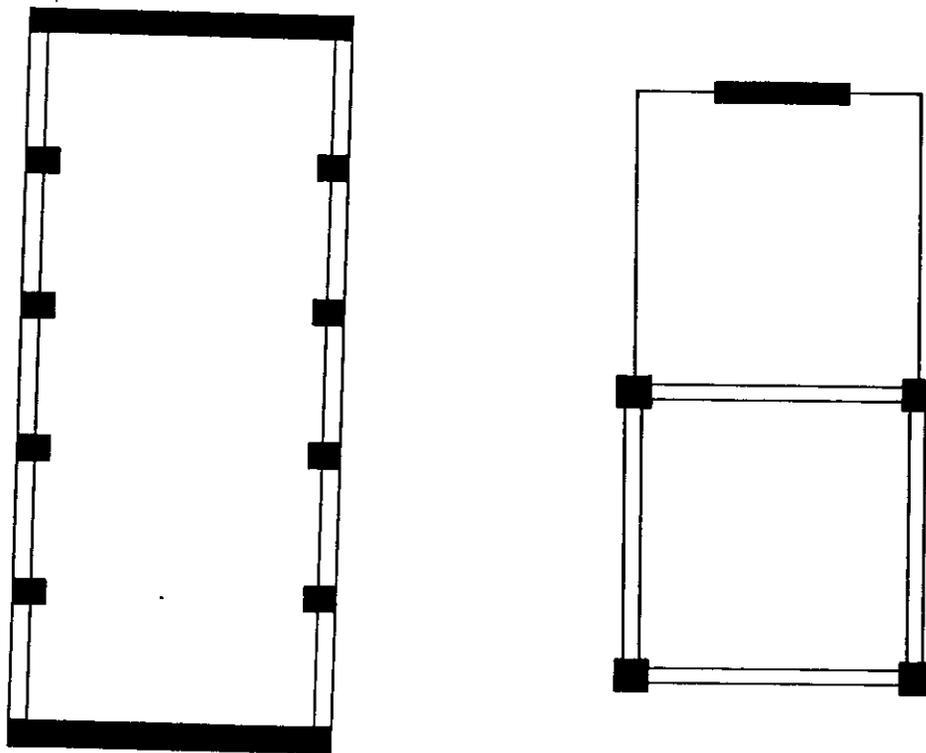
Pórtico Plano Para Resistir aos Esforços Laterais
